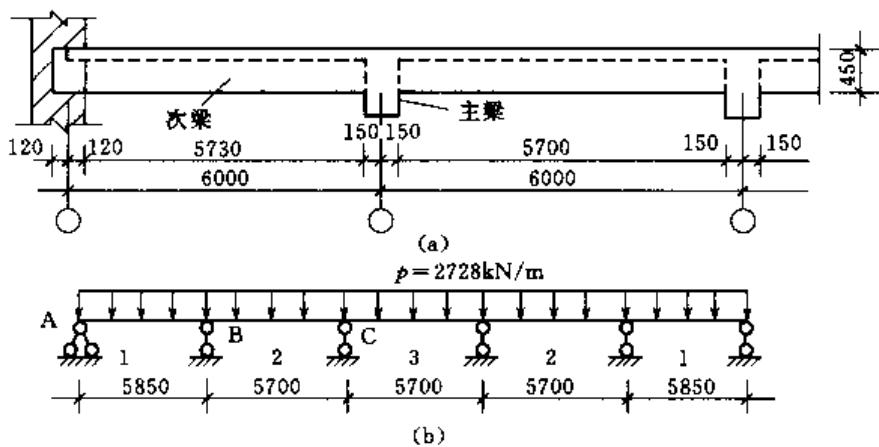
次梁的支承情况及计算简图 (单位: mm)
